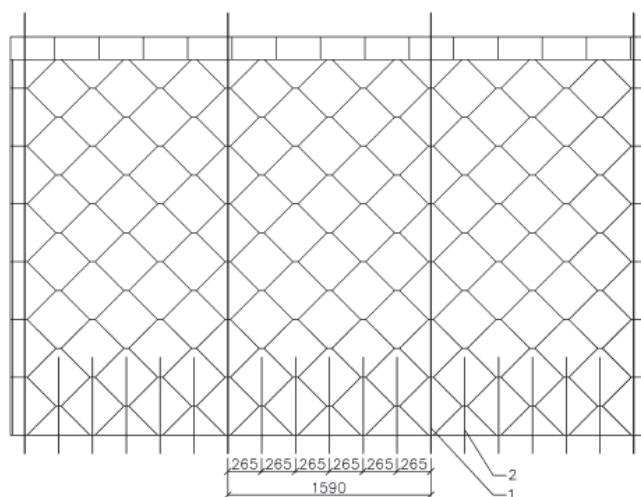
Laťování u okapové hrany [29], [31]
